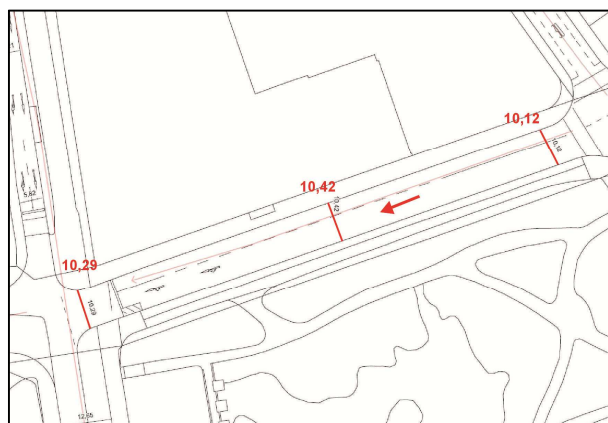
Sanderring (Münzstraße bis Sanderstraße) - Lageplan
